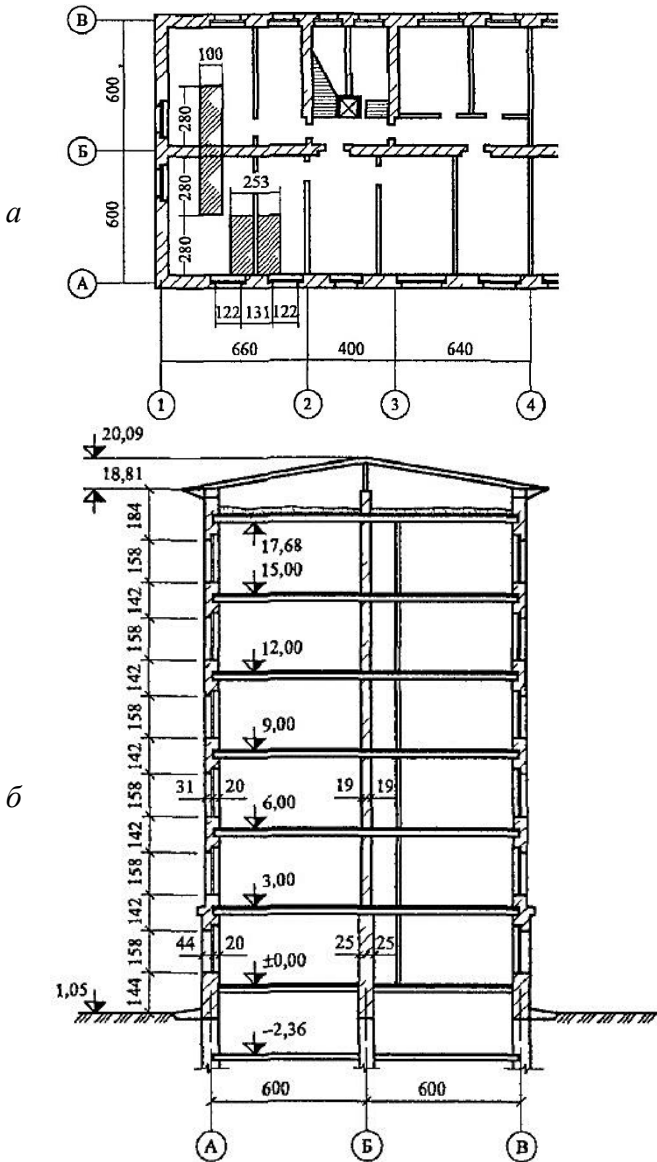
Схема к определению нагрузок на фундаменты шестизэтажного жилого здания:
